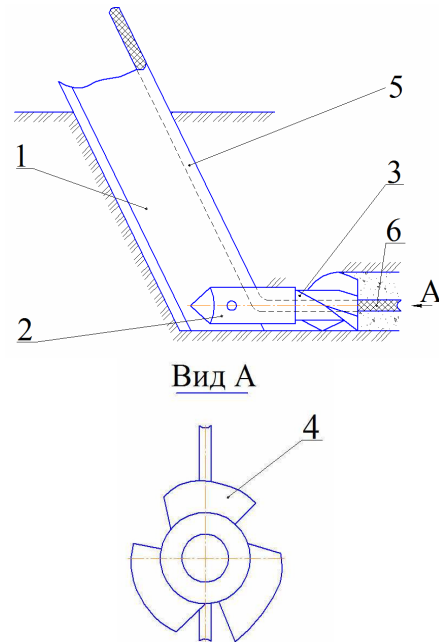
Робочий орган ножово-фрезерного безтраншейного укладача труб: 1 – щілиноріз; 2 – дреномер; 3 – самообертвову фрезу; 4 – руйнівні елементи; 5 – порожнина для подачі лінійно-протяжних об'єктів; 6 – лінійно-протяжний об'єкт
